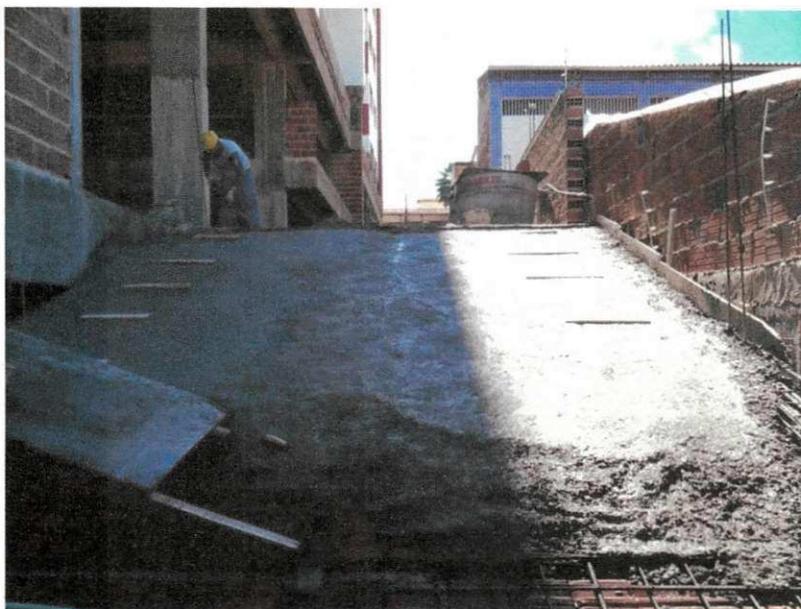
Vista da rampa (pelo térreo) no dia da concretagem
